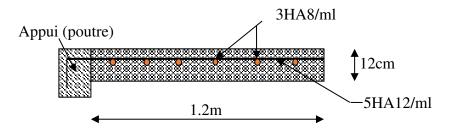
Schéma de ferraillage d'une dalle sur un appui appuis.
